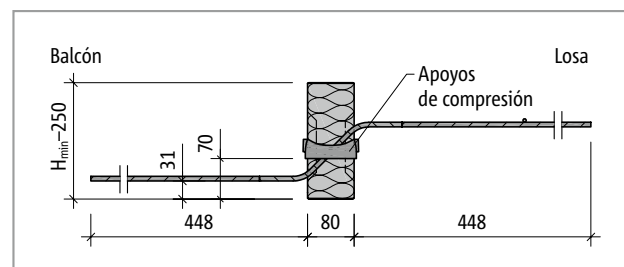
Schöck Isokorb® T tipo Q-V6 en R0: Sección del producto
